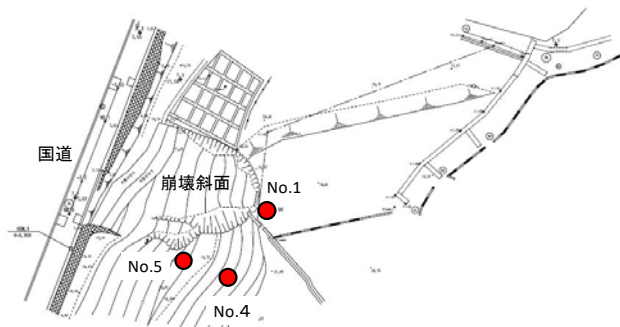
斜面崩壊地の平面図 (門司区大里東地区)
